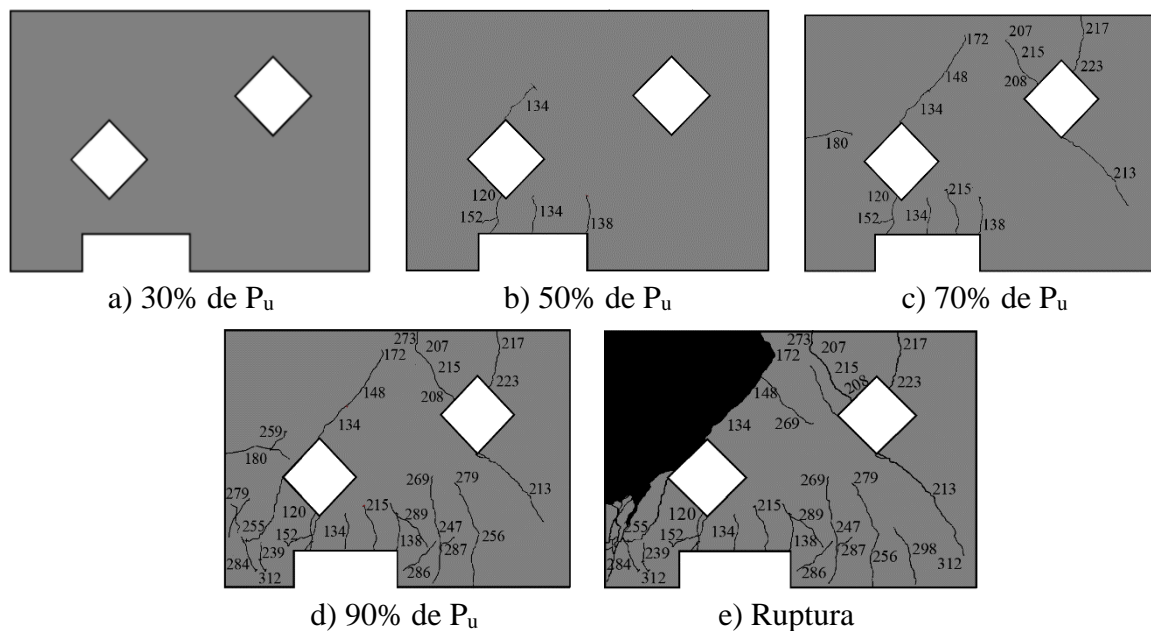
Mapa de fissuração DB2-H2-U-A-1 (força indicada em kN)
